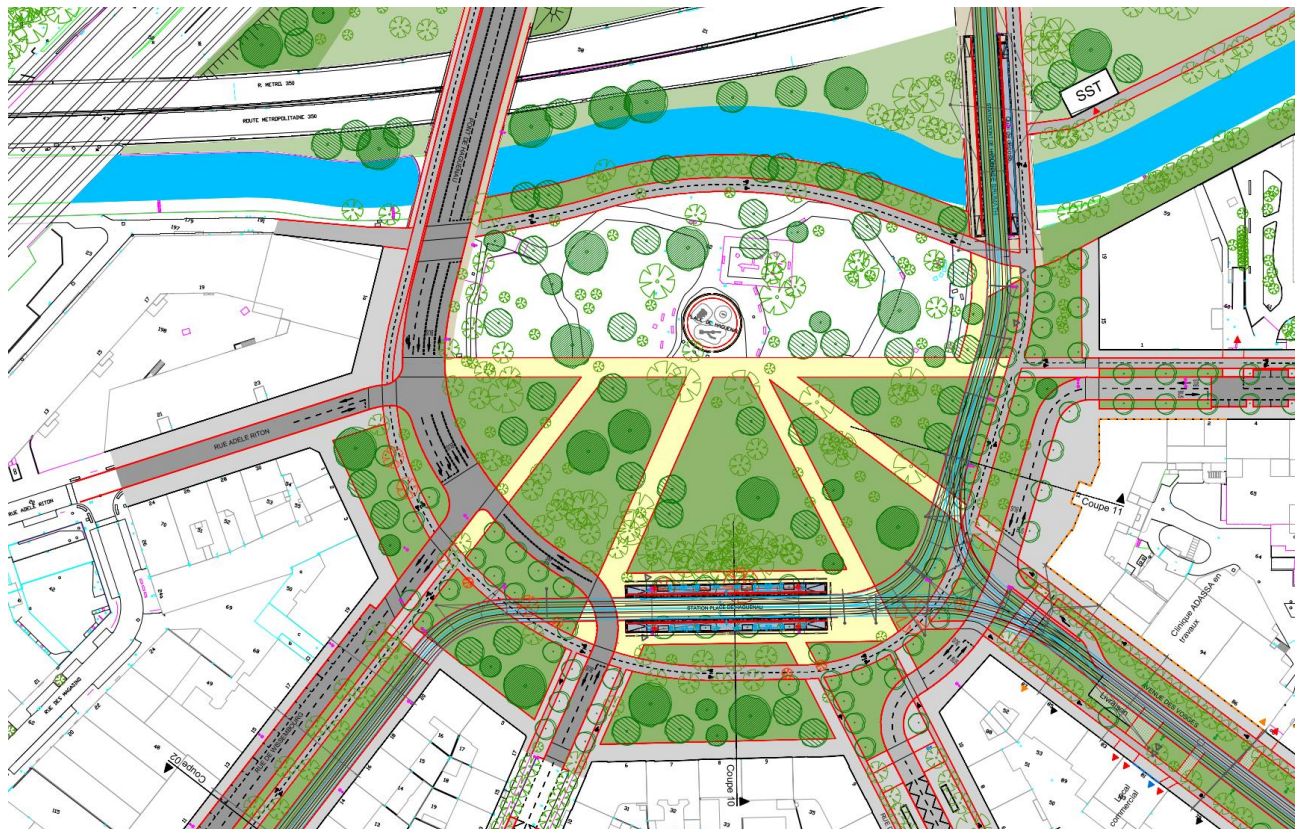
COUPE ET VUE EN PLAN DE LA PLACE DE HAGUENAU AU STADE DE L'AVANT-PROJET
